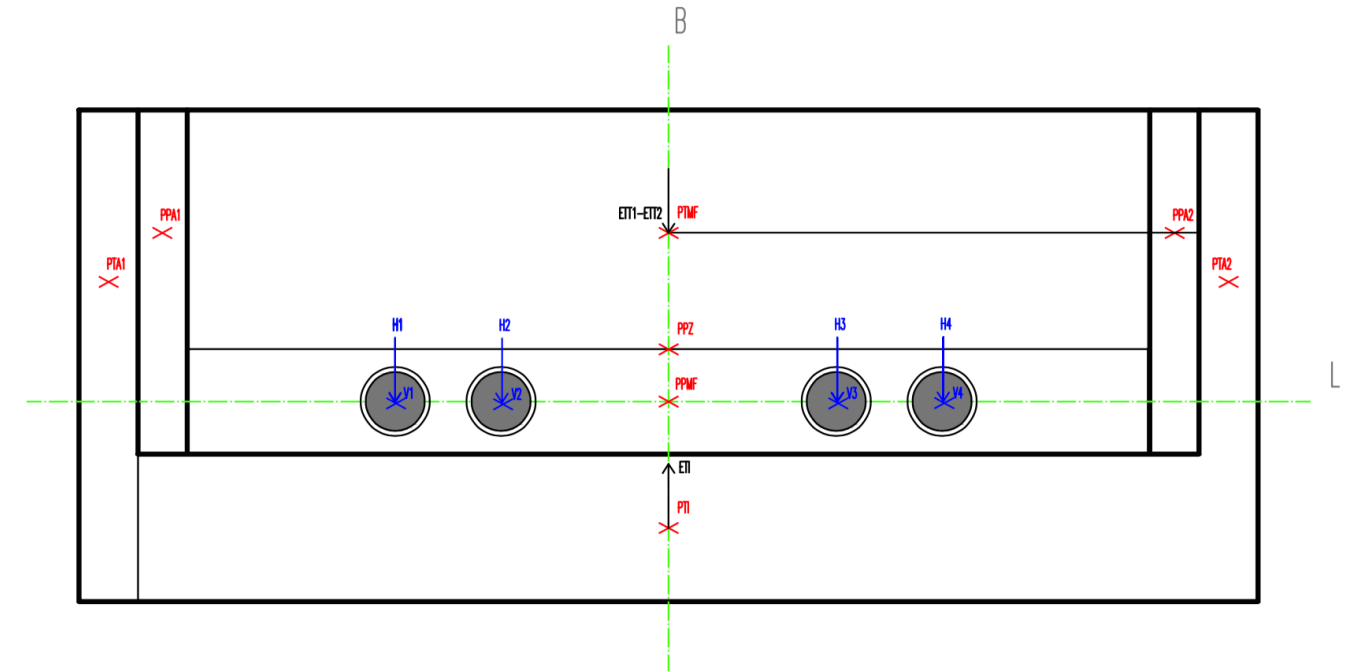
b. Cargas sobre el estribo. Planta estribo
